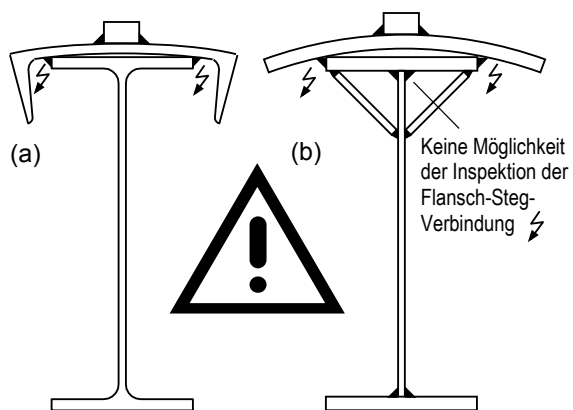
Beispiel zu vermeidender geschweißter Querschnitte: (a) unsicherer Kontakt der Querschnittsteile, (b) nicht inspizierbare Verbindungen
